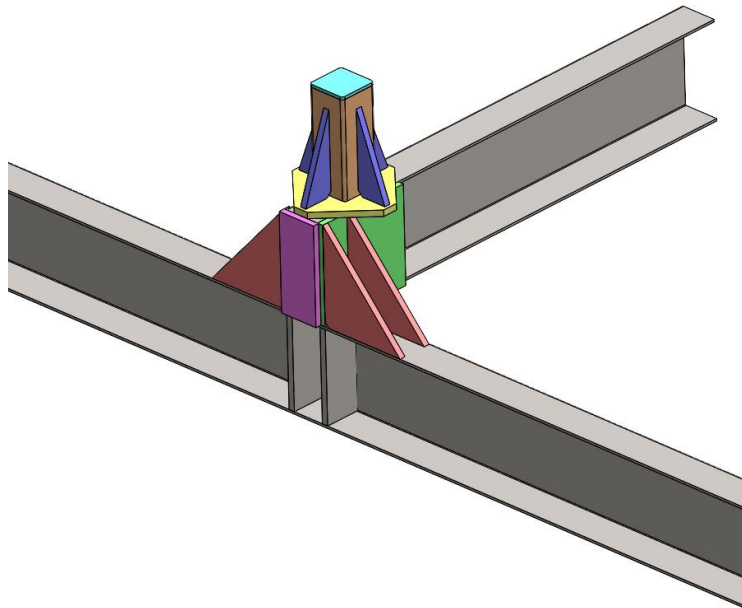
fixação do pilarete com reforço metálico na estrutura do telhado para os pontos 23 a 29.
